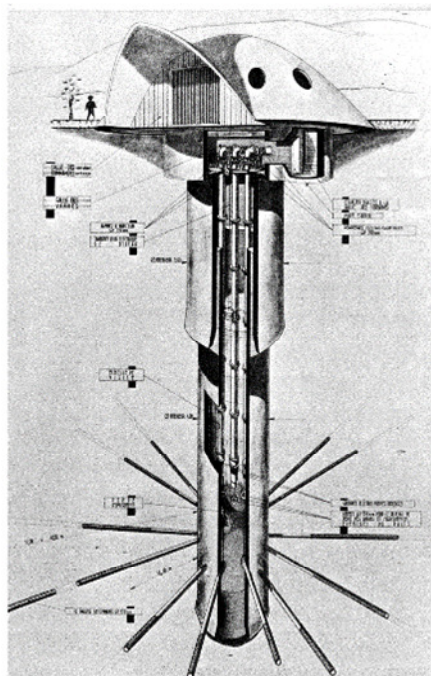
Schéma d'un puits à drain rayonnant Drac
